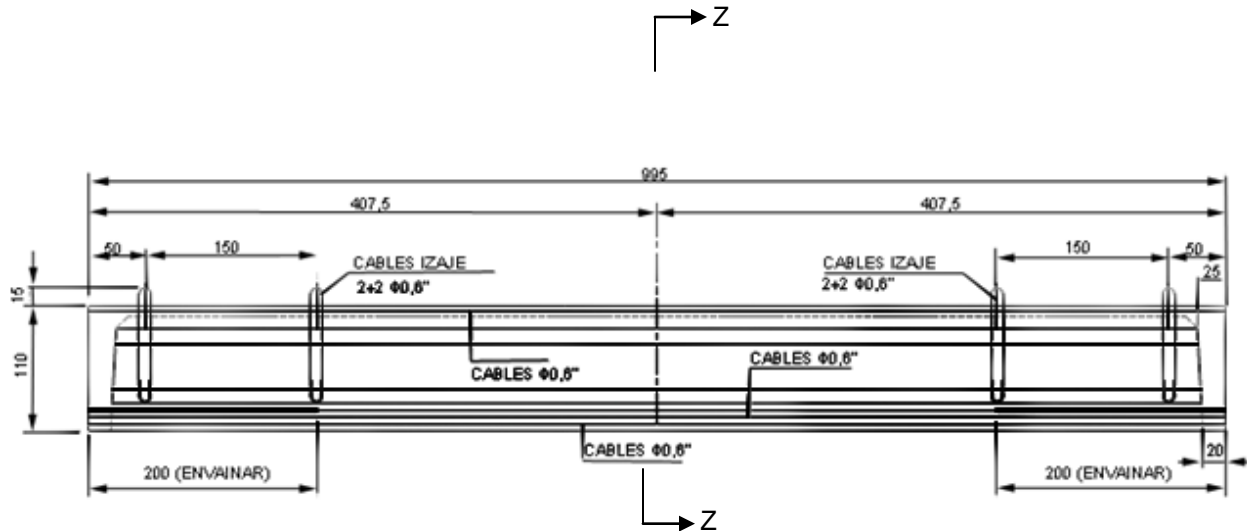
Elevación unidad pretensada prefabricada compuesta por dos vigas.
